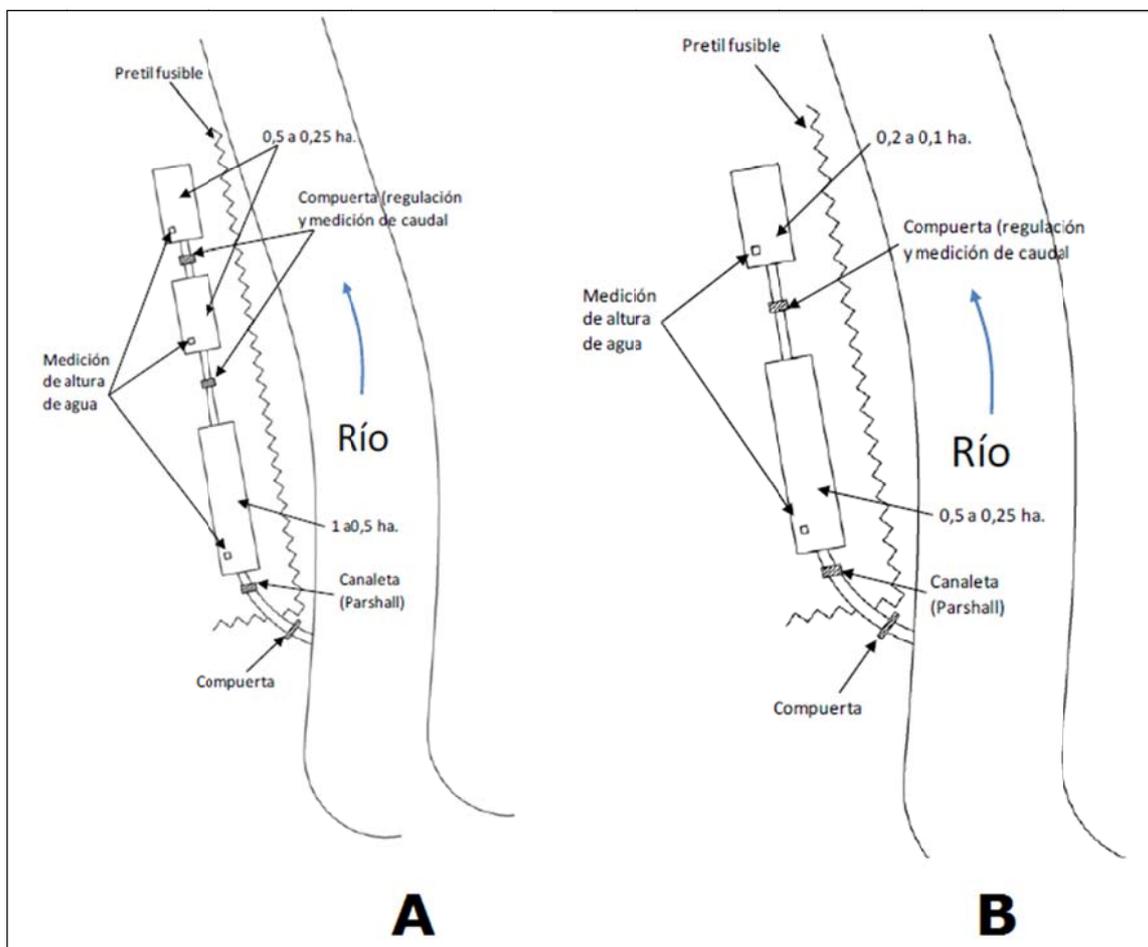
Vista en planta del diseño preliminar de balsas de infiltración para 1ra sección (A) y 2da sección (B)
